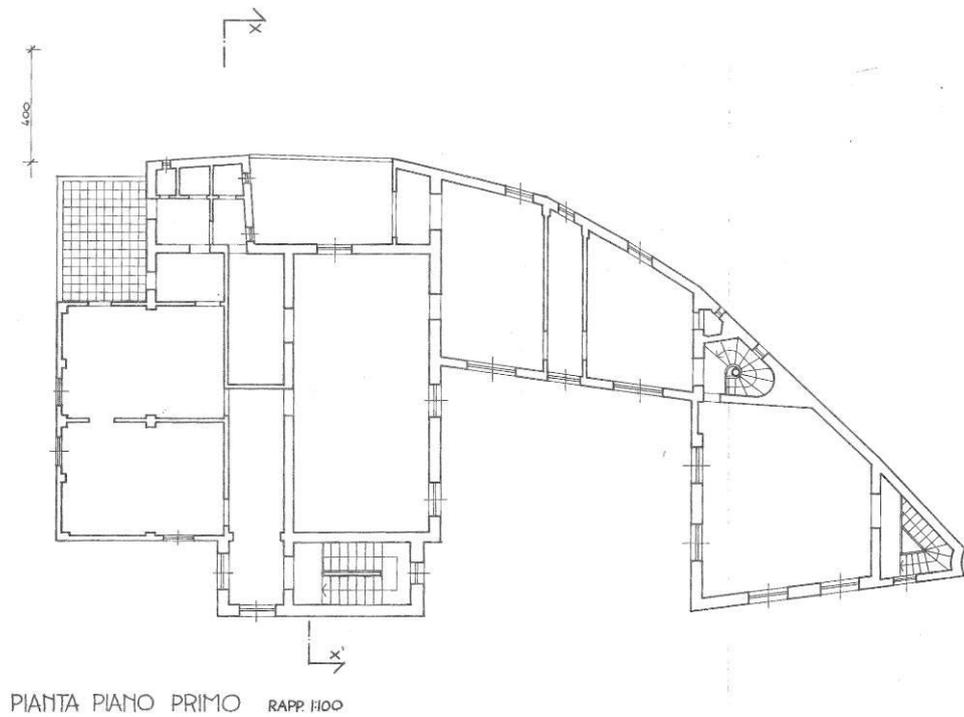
Planimetria Palazzina "M" - Piano Primo
